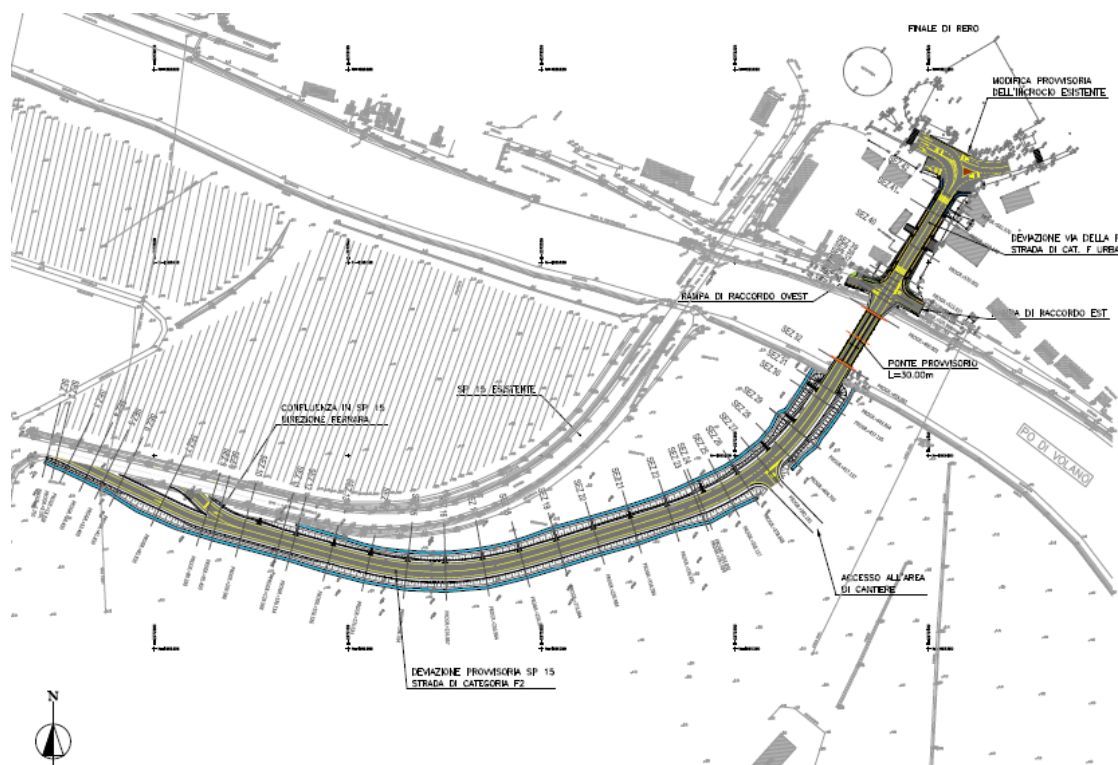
Planimetria viabilità provvisoria Final di Rero
